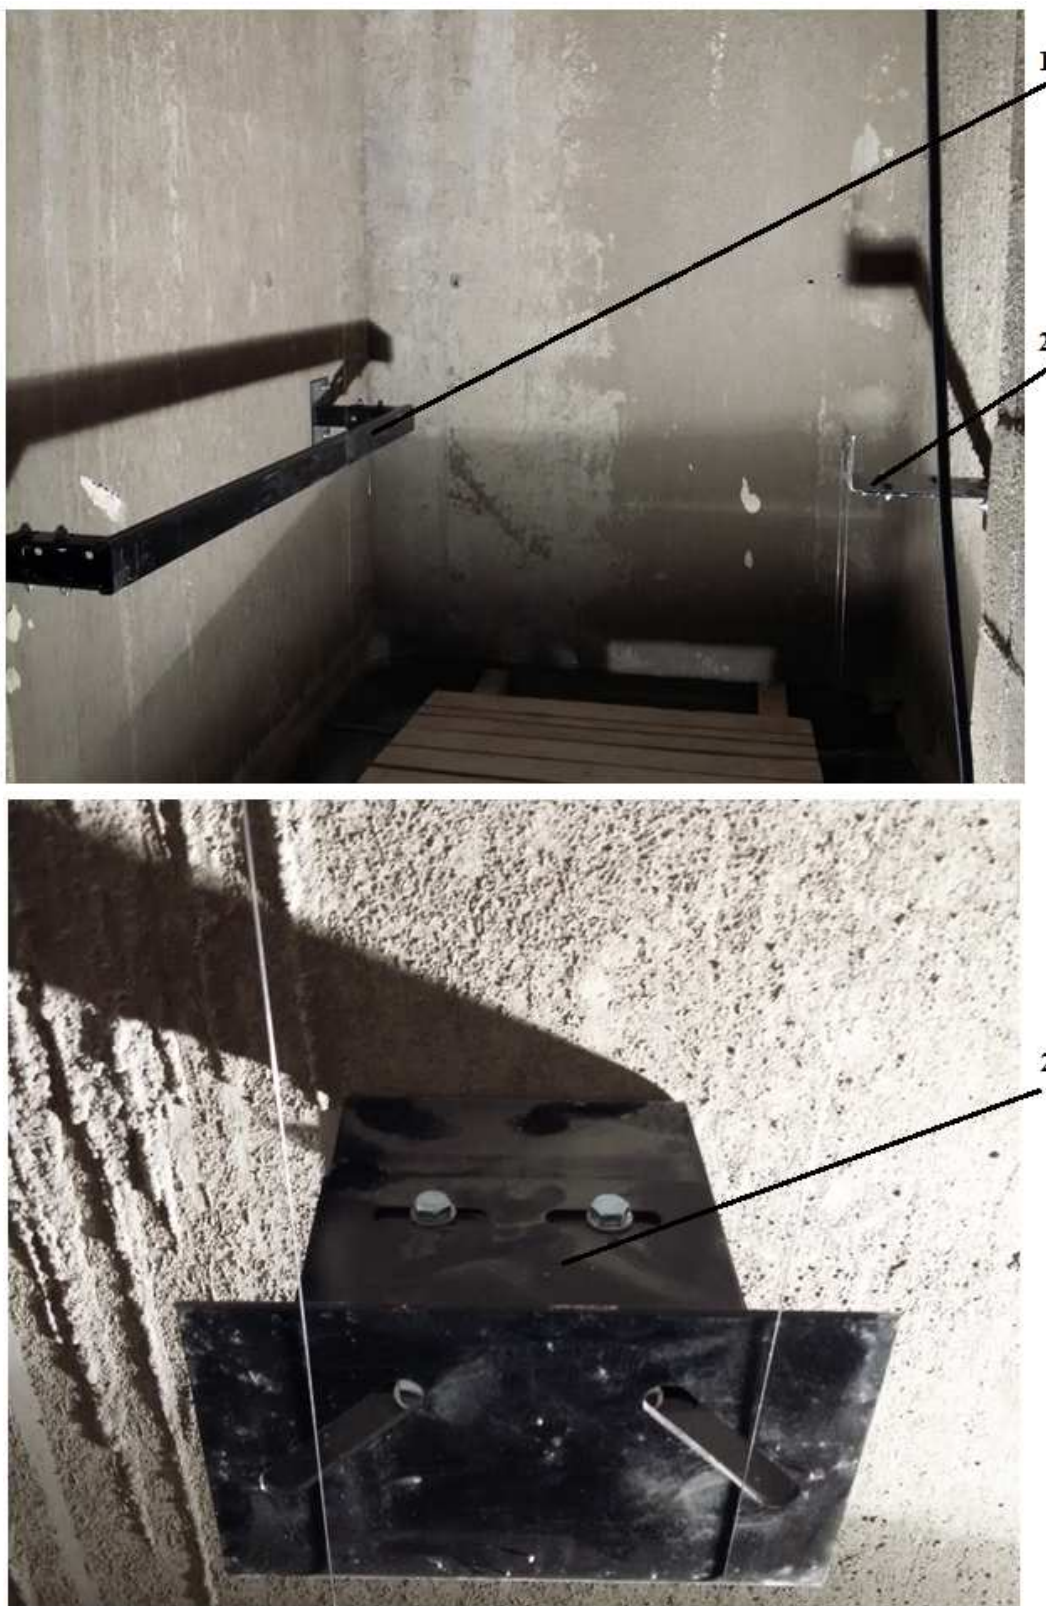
Кронштейны кабины и противовеса при боковом расположении противовеса
